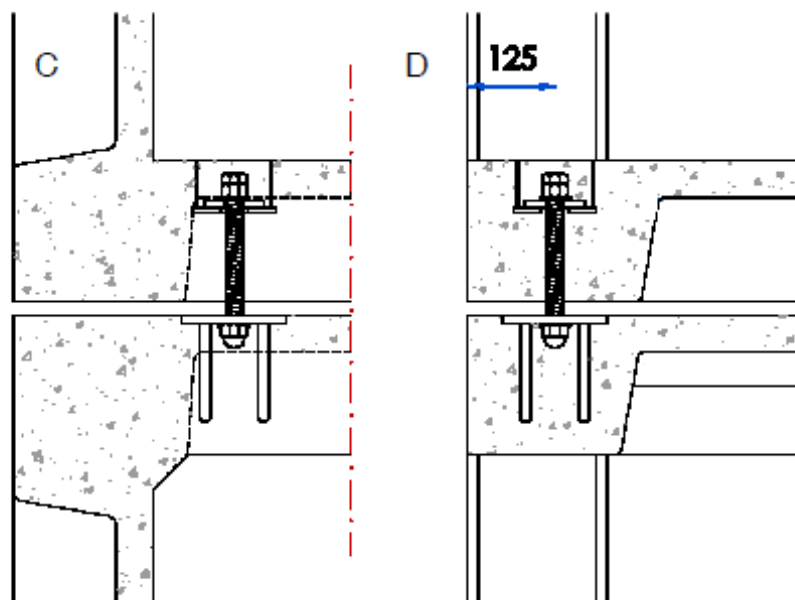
Secciones transversales del anclaje vertical. Sin aberturas (C) y en losa armada de una abertura (D).
